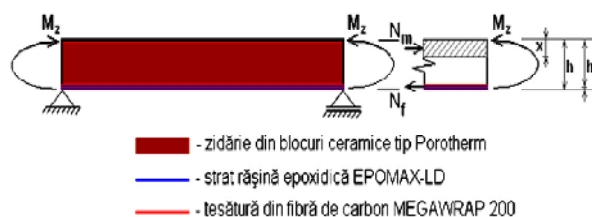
Schema de calcul a secțiunilor dreptunghiulare la încovoiere
